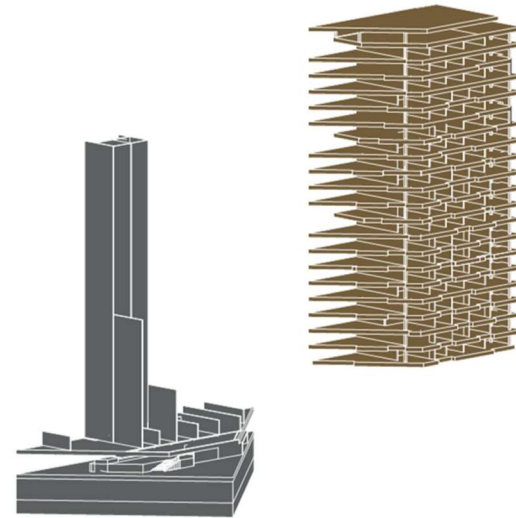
Esquema del sistema híbrido hormigón – madera. Solución adoptada para la construcción del edificio.
